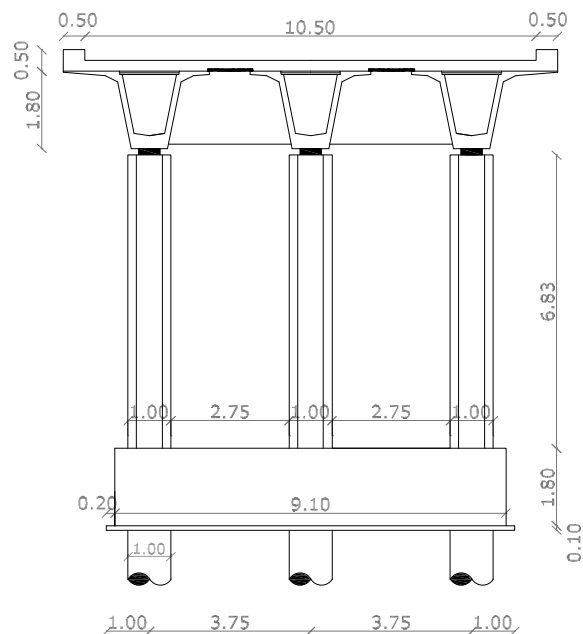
Vista laterale dei ritzi delle pile con sezione trasversale dell’impalcato.
